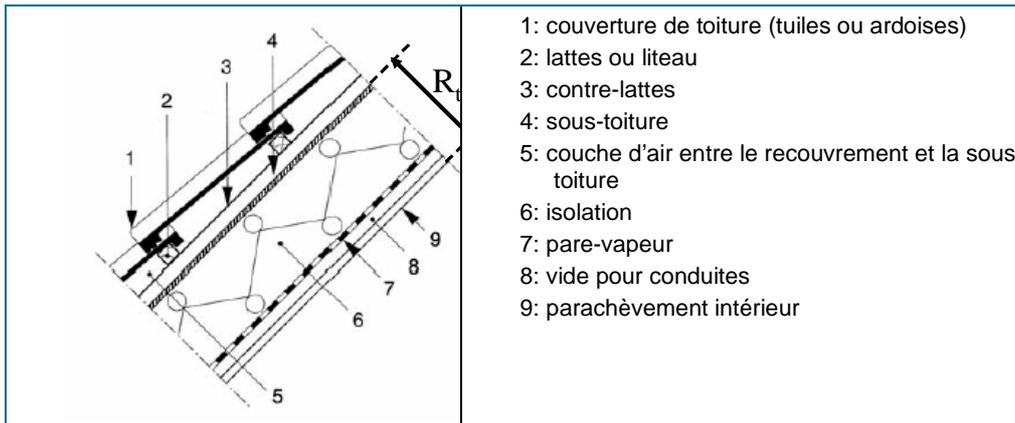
Coupe d'une toiture en tuiles ou en ardoises
